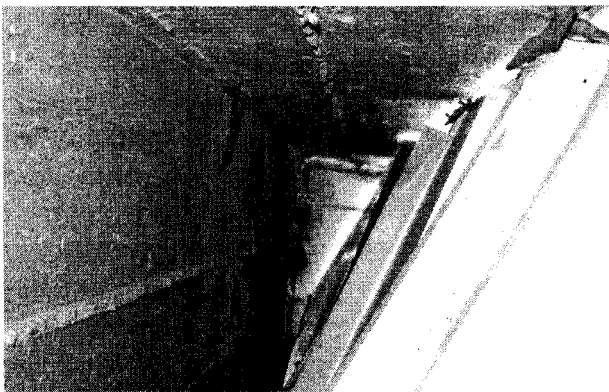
Вигляд на зовнішнє опорне залізобетонне кільце Z-подібного перерізу
